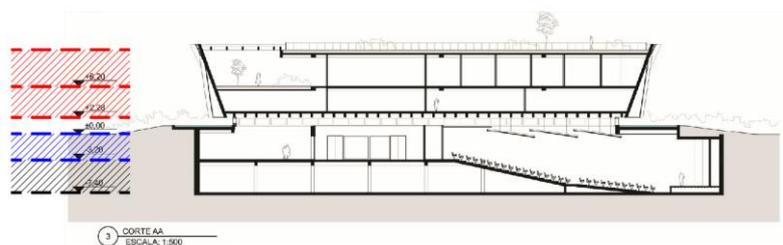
Corte AA, evidenciando estrutura dos pavimentos, orla_p006
